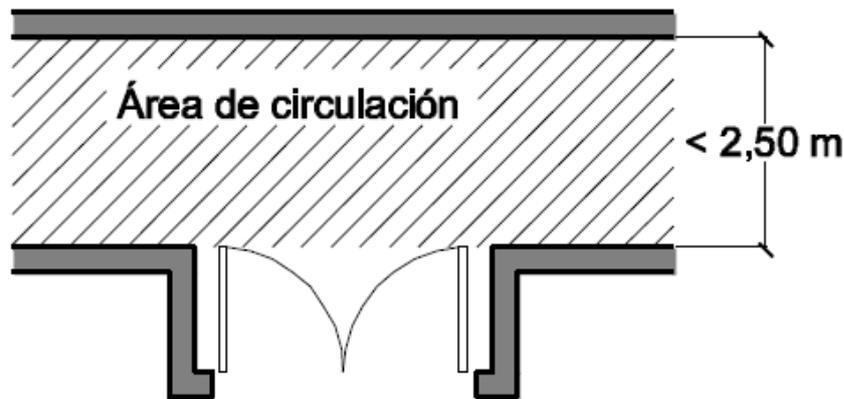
Disposición de puertas laterales a vías de circulación.
